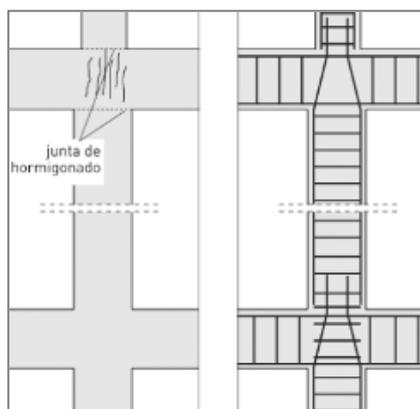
Fisuración vertical en nudos de pórticos.
